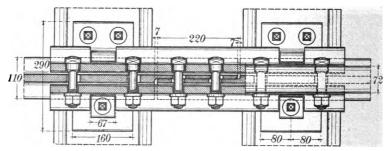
b. Grundriß und Aufsicht. M. 1:10.
